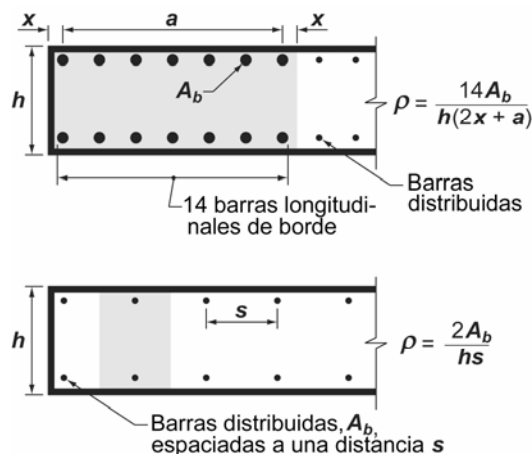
Cuantía de refuerzo longitudinal para condiciones típicas de borde en el muro.
